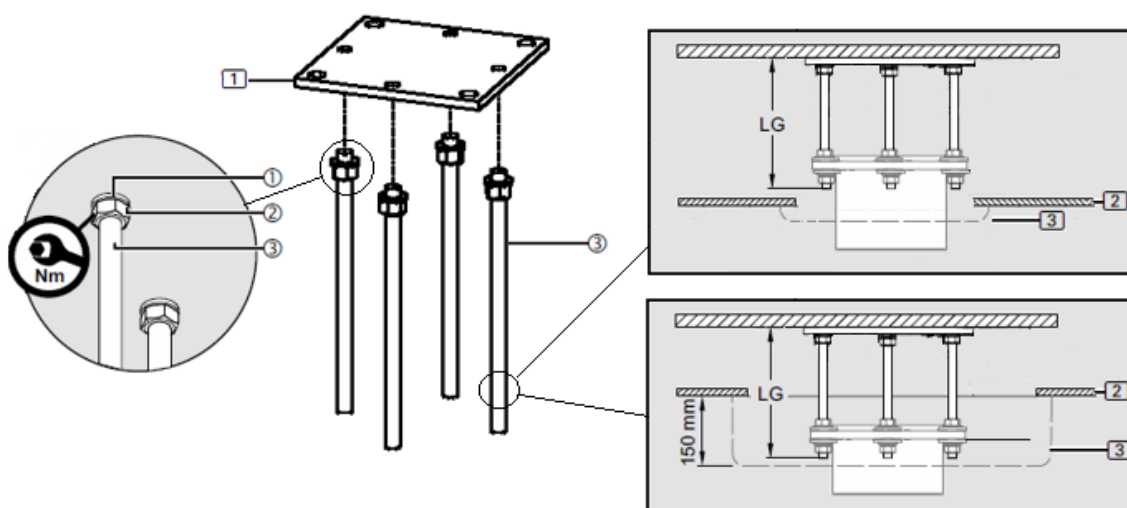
Installation de la plaque d'interface dans une pièce avec faux plafond
